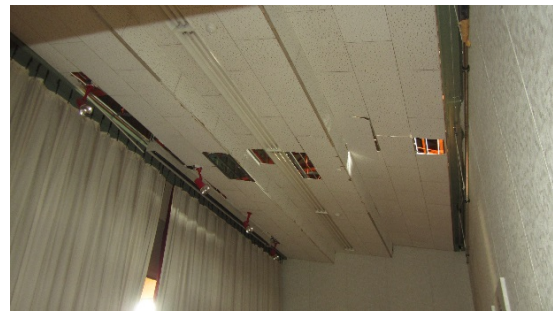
舞台の天井の損傷・一部脱落
